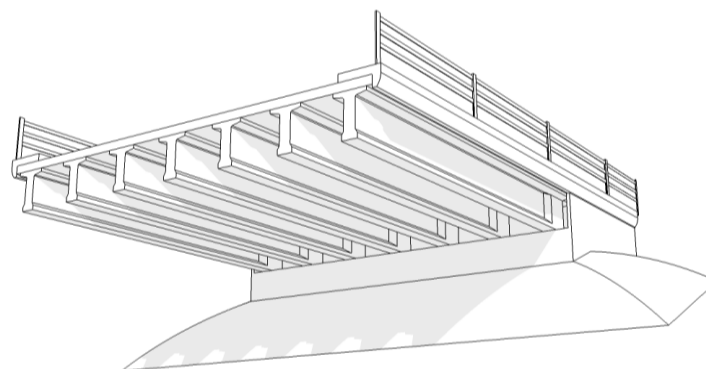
Morphologie générale d'un pont à poutres en béton précontraint
